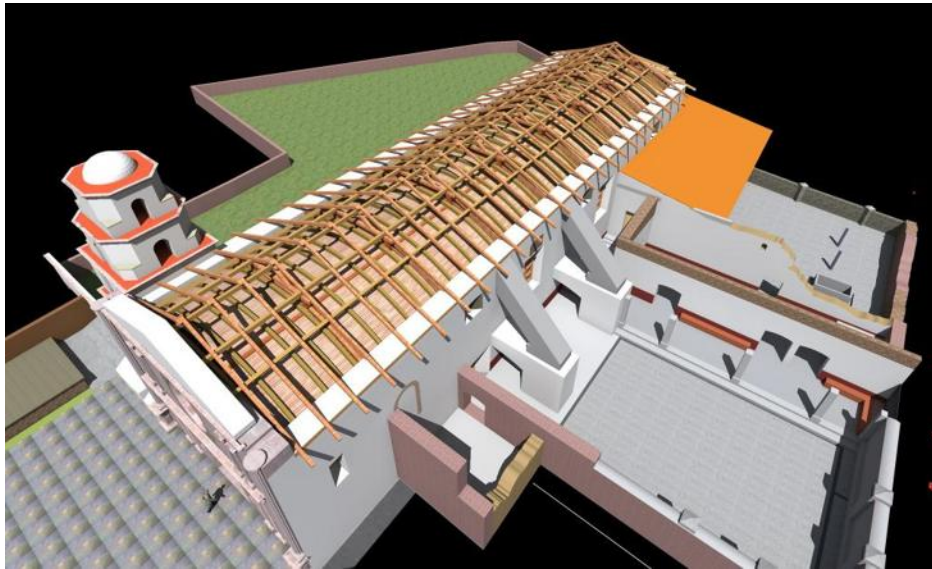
Estructura interior soportante de la cubierta de teja.
